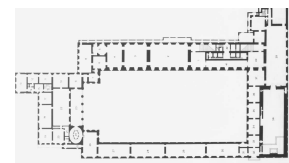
Grundriss des Piano Nobile des Quirinalpalasts nach den Umgestaltungen im 19. Jh.
